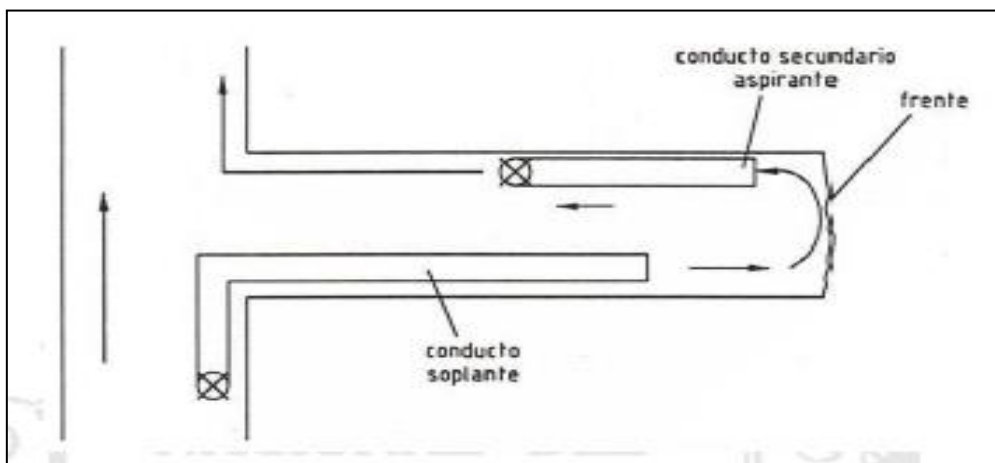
Ventilación Mixta. Fuente: Suty, 2016, p 38.
